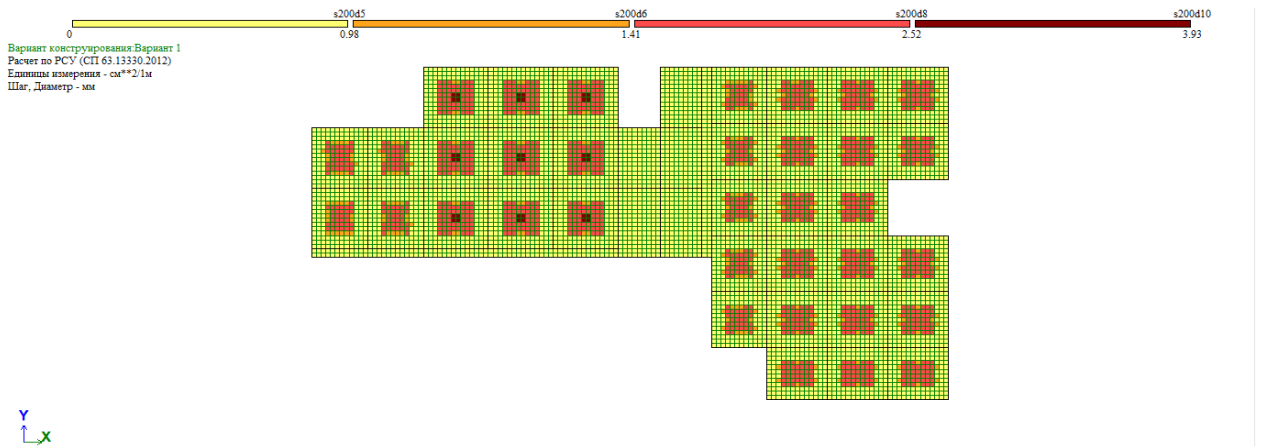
Площадь арматуры по нижней грани плиты перекрытия по оси Y
